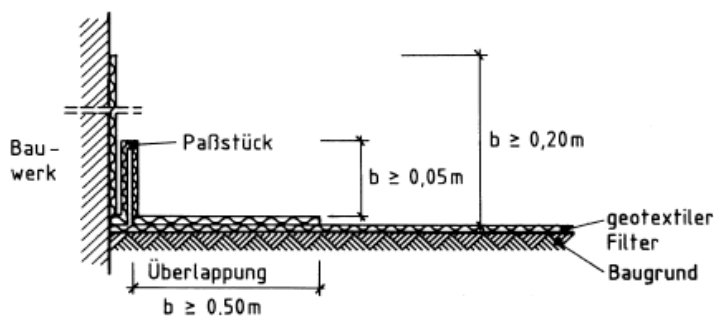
Bauwerk mit ebener Anschlußfläche [77]
